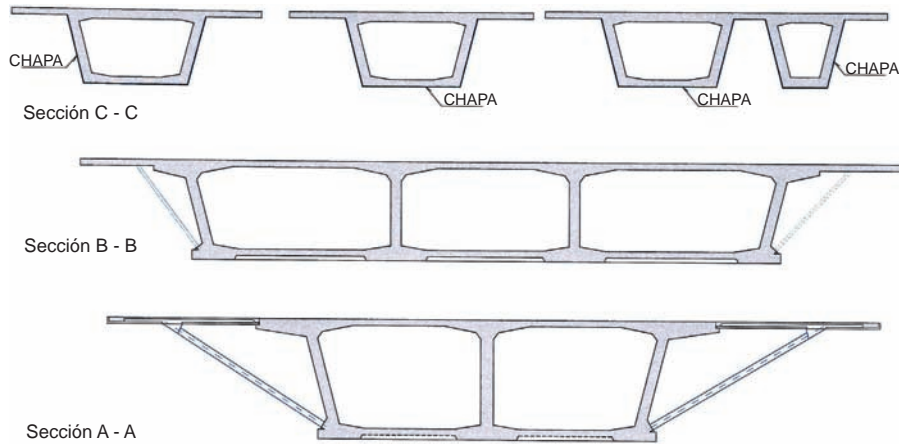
Viaducto zona de transición. Secciones fundamentales.
